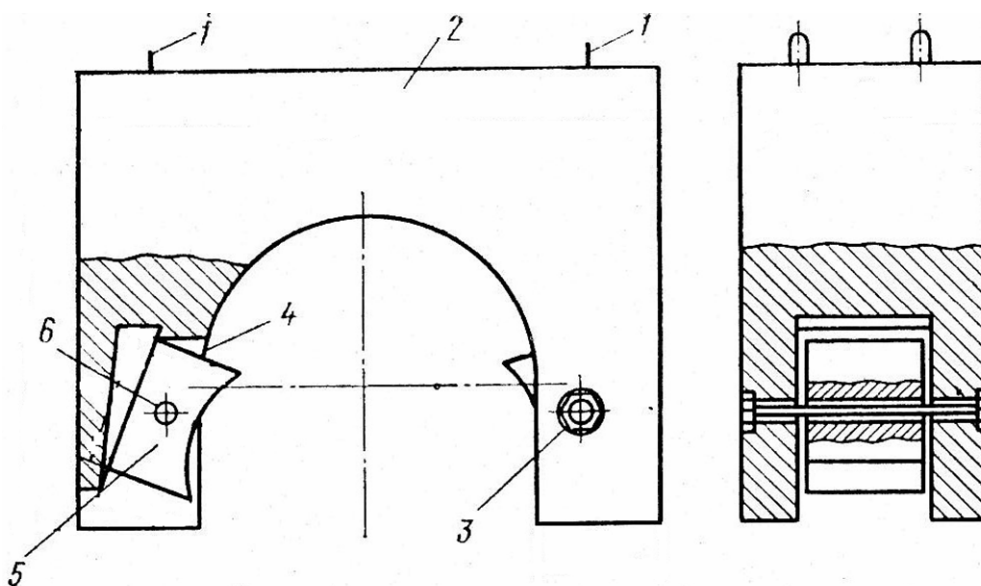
Конструкция утяжелителя седловидного самозакрепляющегося типа УСС: 1 — монтажные петли; 2 — блок; 3 — болт и гайка; 4 — стопорное приспособление; 5 — прижимной элемент; 6 — металлическая ось
